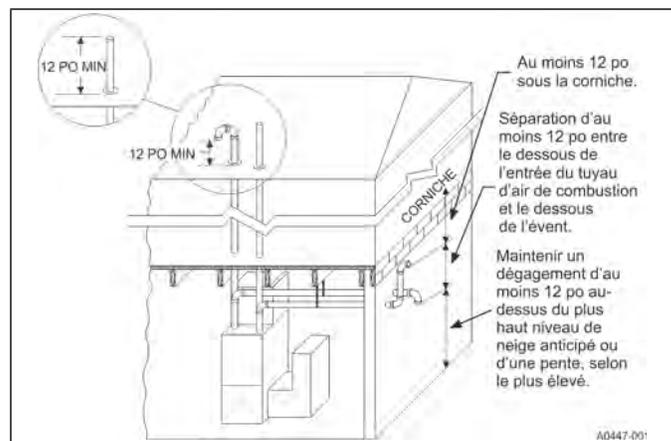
Configuration de sortie – 2 conduits, installation au sous-sol
